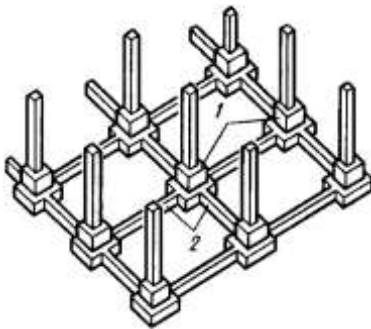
Схема стовпчастих фундаментів із антисейсмічними зв'язками: 1 — фундаменти під колони; 2 — залізобетонні фундаментні балки
